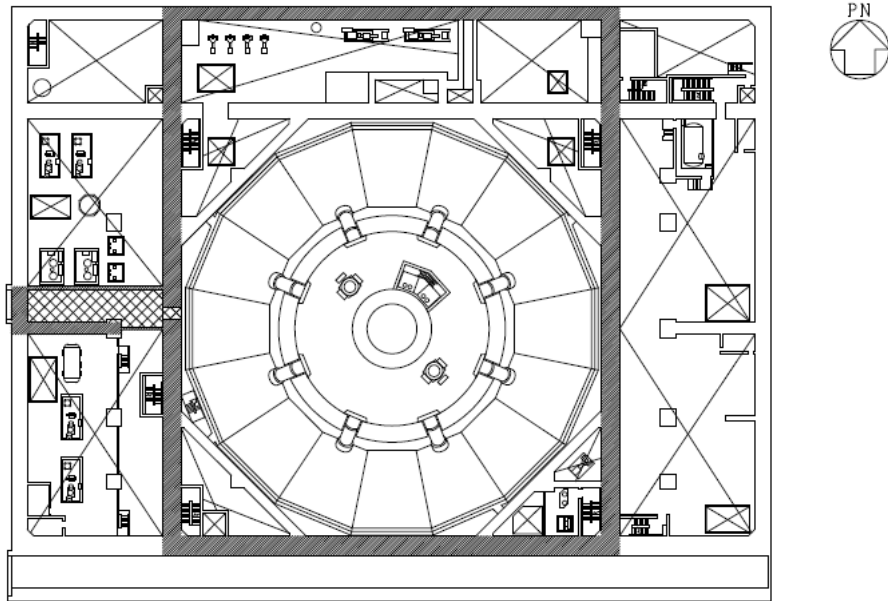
(1) 原子炉建物原子炉棟 (二次格納施設) の範囲の平面図
